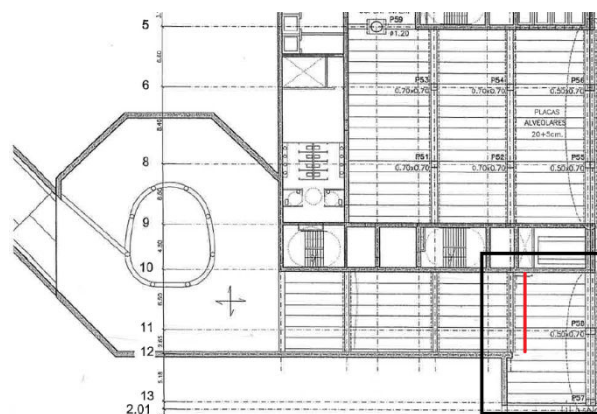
Plano de planta de la estructura de forjado de la planta -1, identificando el paño afectado y la localización aproximada de la fisura (en color rojo)
